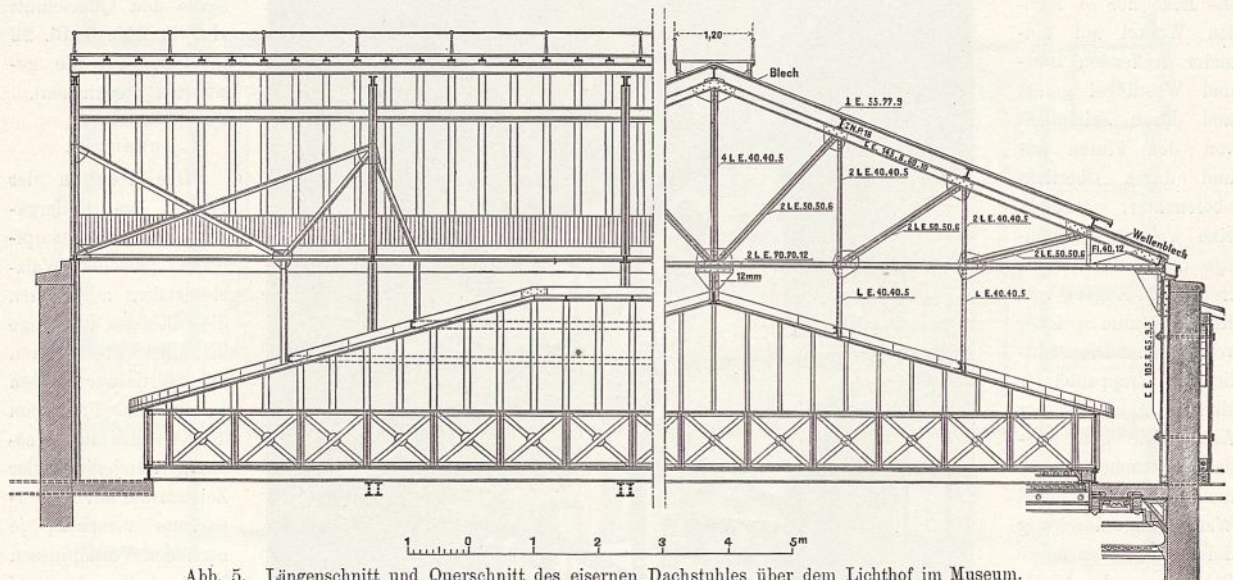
Längenschnitt und Querschnitt des eisernen Dachstuhles über dem Lichthof im Museum.
